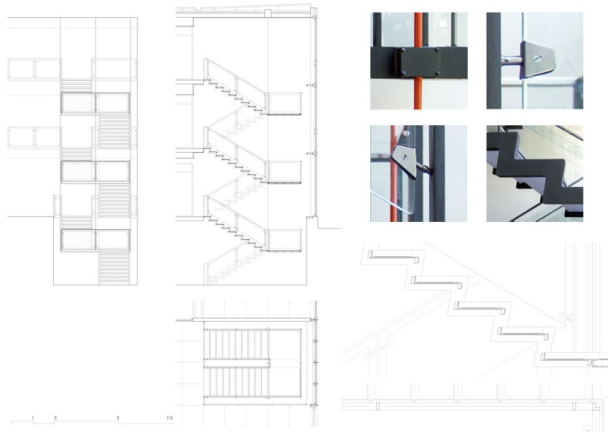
Planta, alzado y sección vertical de la escalera de Rodovre. Fotografías de detalles. 2011. Foto-autor.
